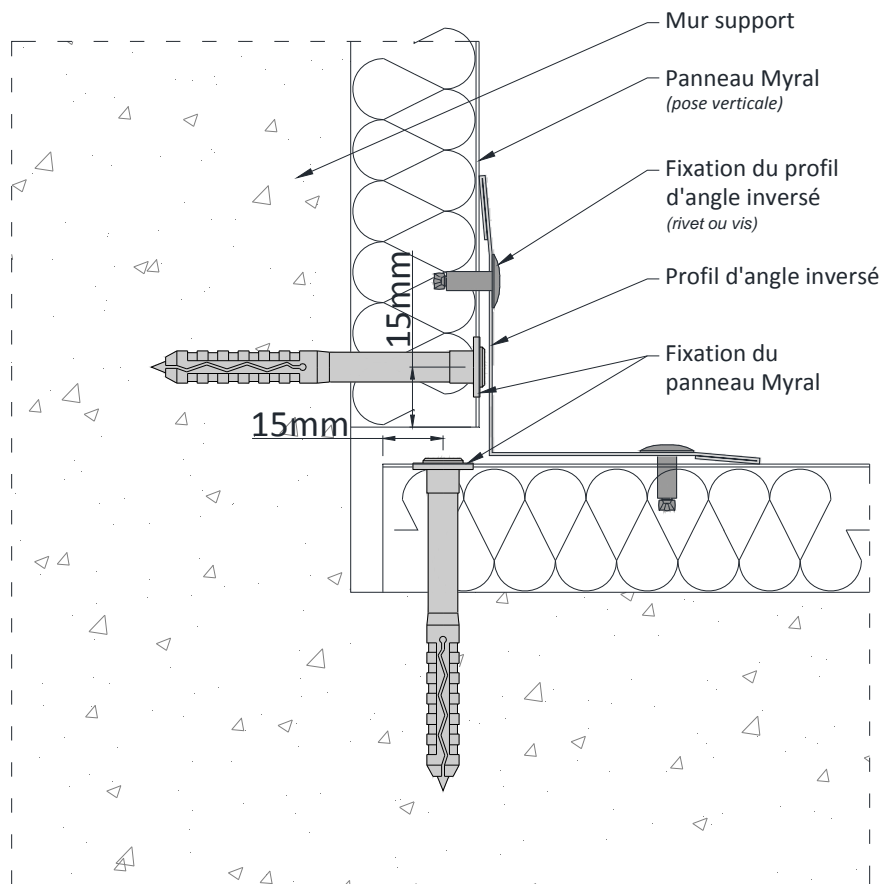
Angle rentrant – Pose en vêtire, pose verticale (coupe horizontale)
